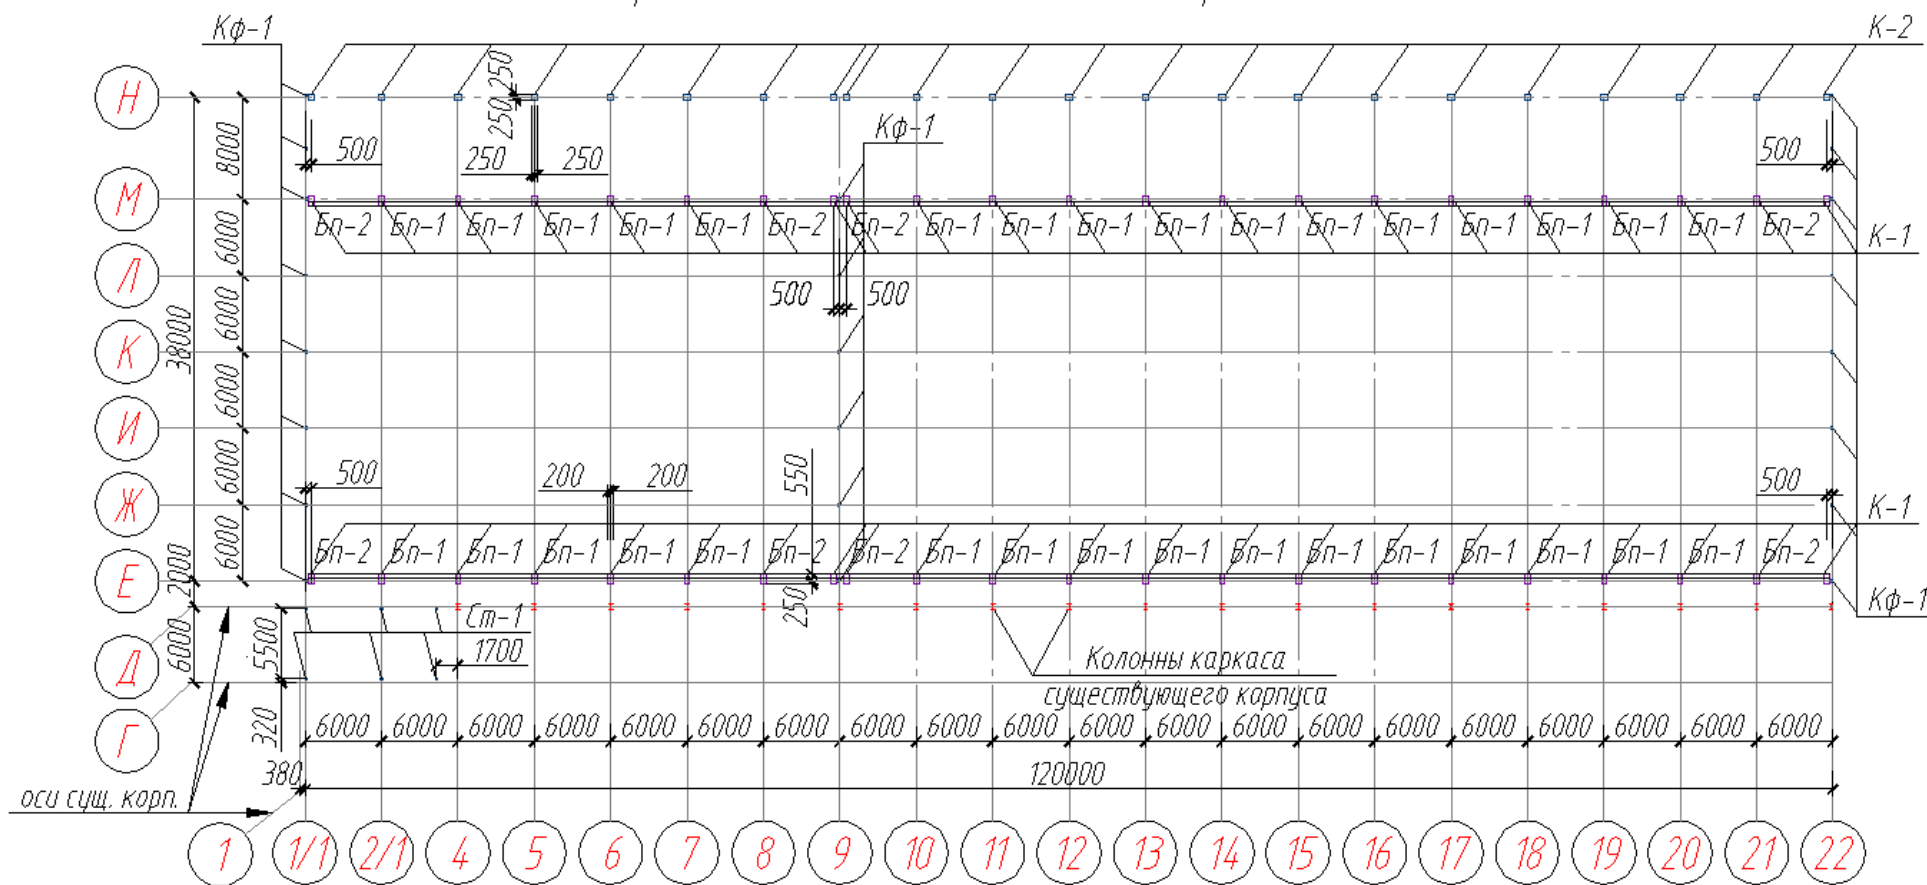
Схема расположения колонн и подкрановых балок
